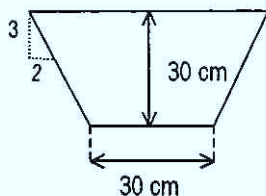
Sezione di progetto del canale di drenaggio n.1.
